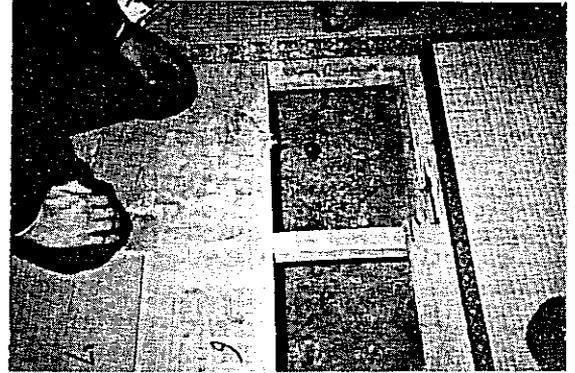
Kleiner Krater unterhalb des Holzfußbodens im Erdgeschoß.
